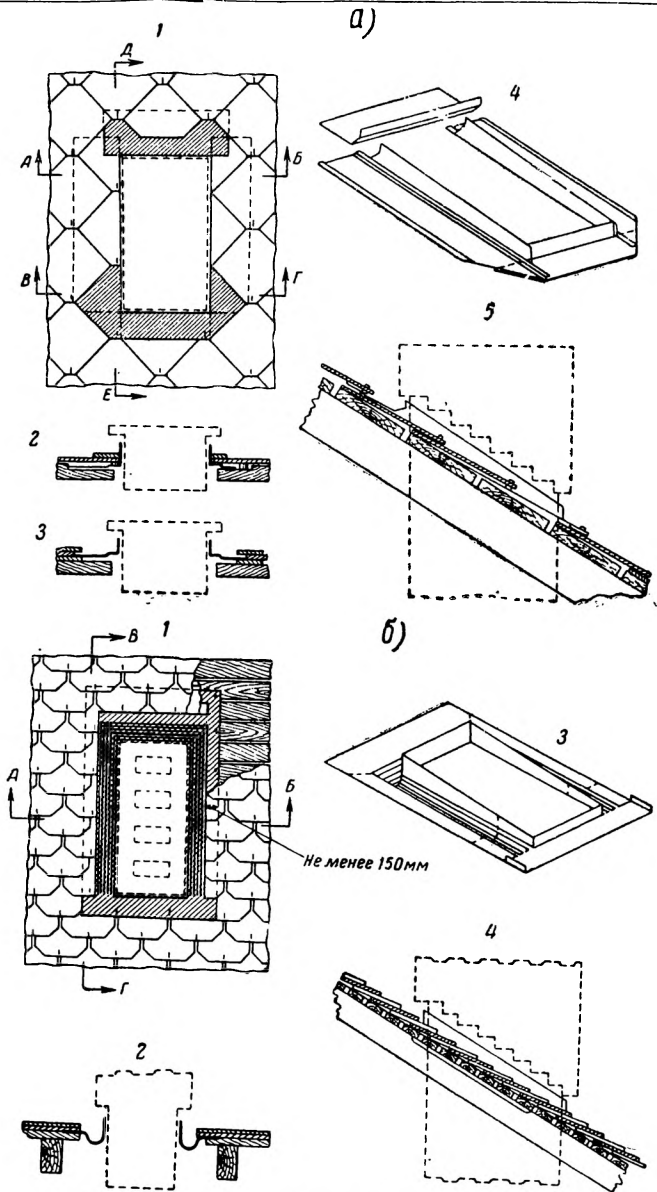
Примыкание кровли из асбестоцементных плиток к дымовой трубе:
